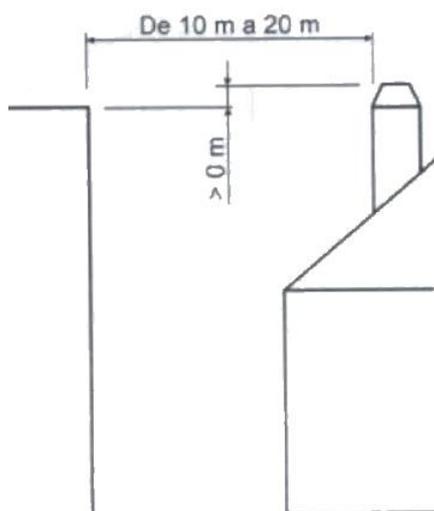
Distanza tra la finitura e oggetti tra 10 e 20 m
